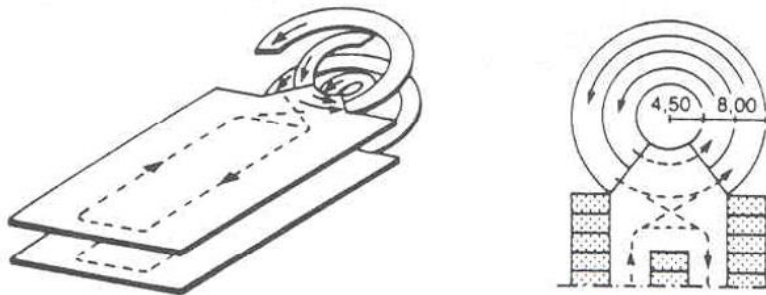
Celorampový parking s točitou parkovací rampou [3]
